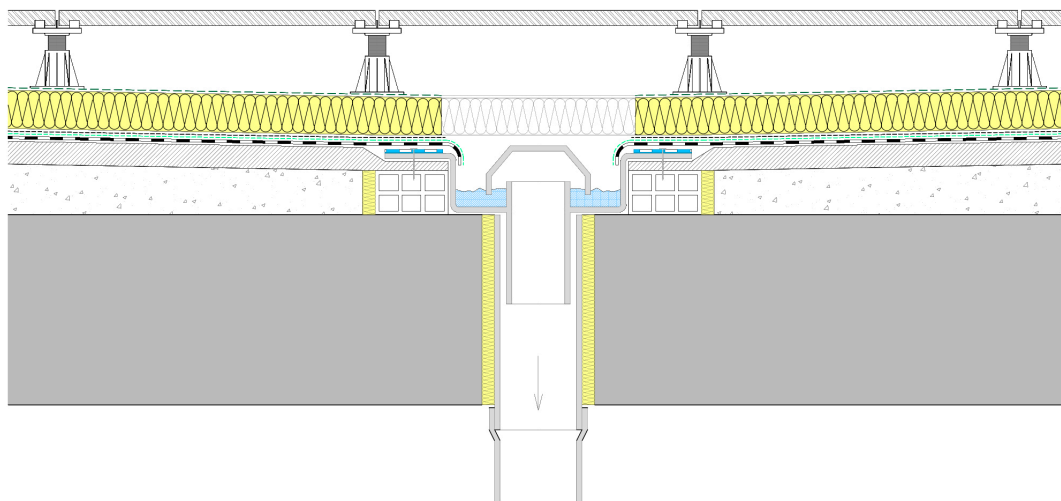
Sumidero en zona con pavimento flotante en cubierta invertida, sin continuidad de capa drenante y lámina filtrante.
